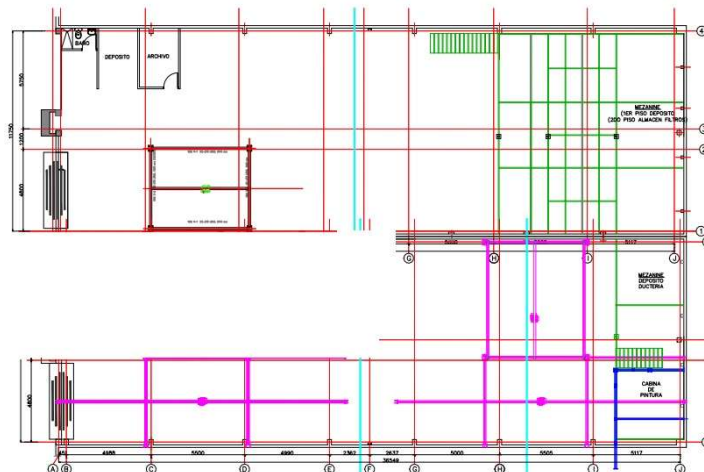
Plano de Planta - Estructura en forma de 'U'. Fuente: Venfil Ingeniería SAS
